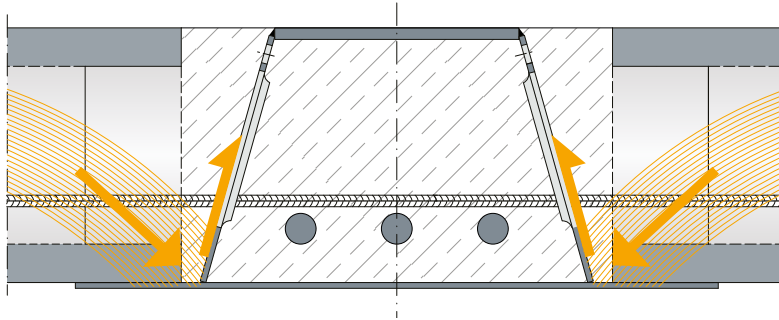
Pionowe zbrojenie zapewniające połączenie belki DELTABEAM® z belką-ścianą.
